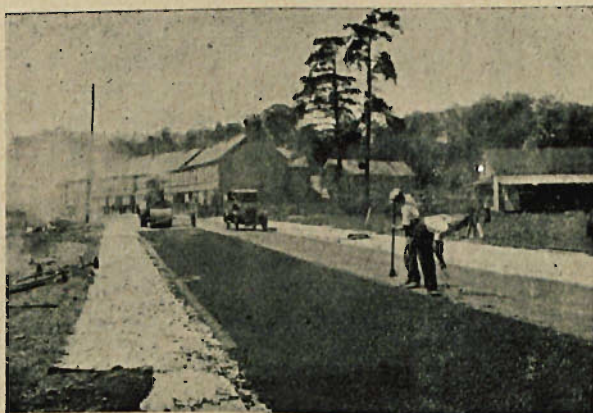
Wysypywanie mieszanki asfaltu walcowanego na gotowe podłoże
